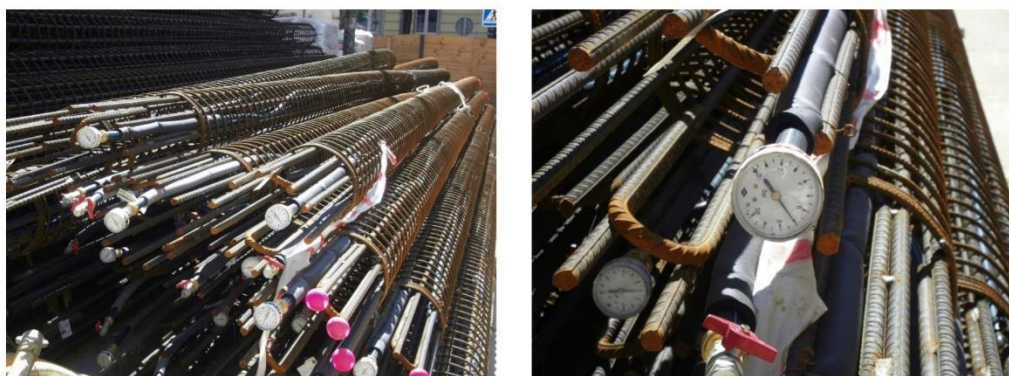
Pruebas en las sondas. Tomado de: www.Construction21.org
